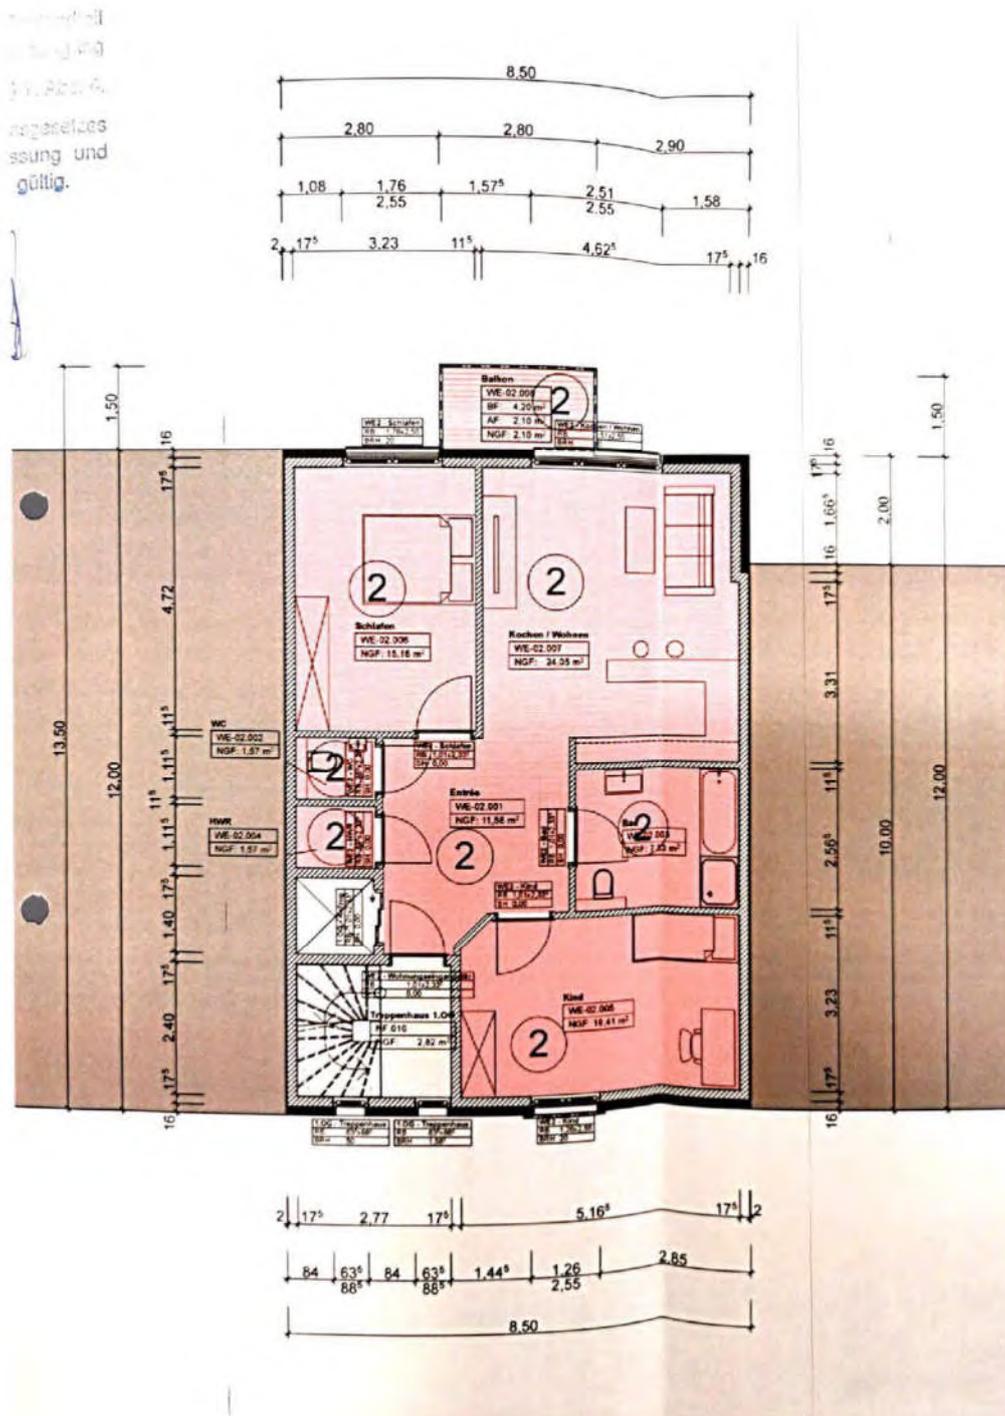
Grundriss 1.OG mit Wohnung Nr. 2
